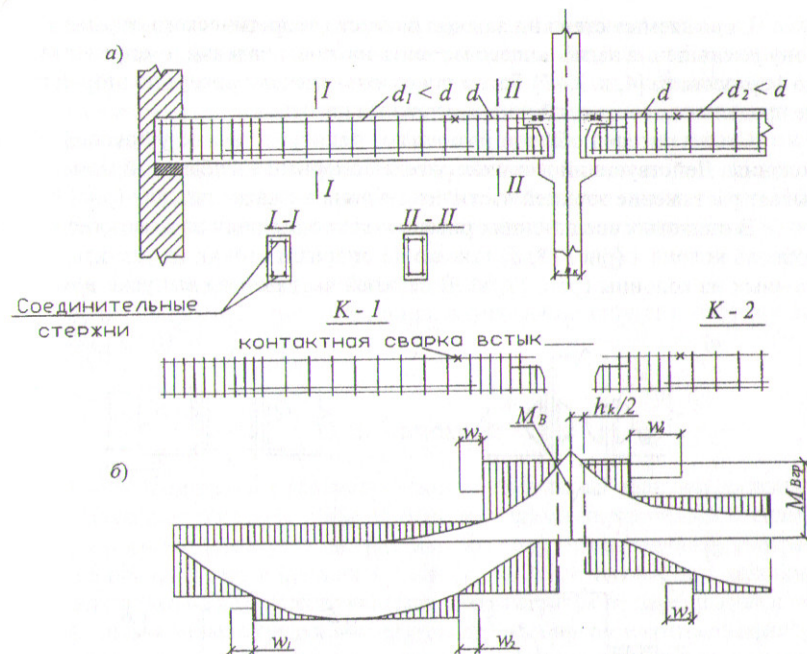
Армирование ригеля (а) и эпюра арматуры (б)
